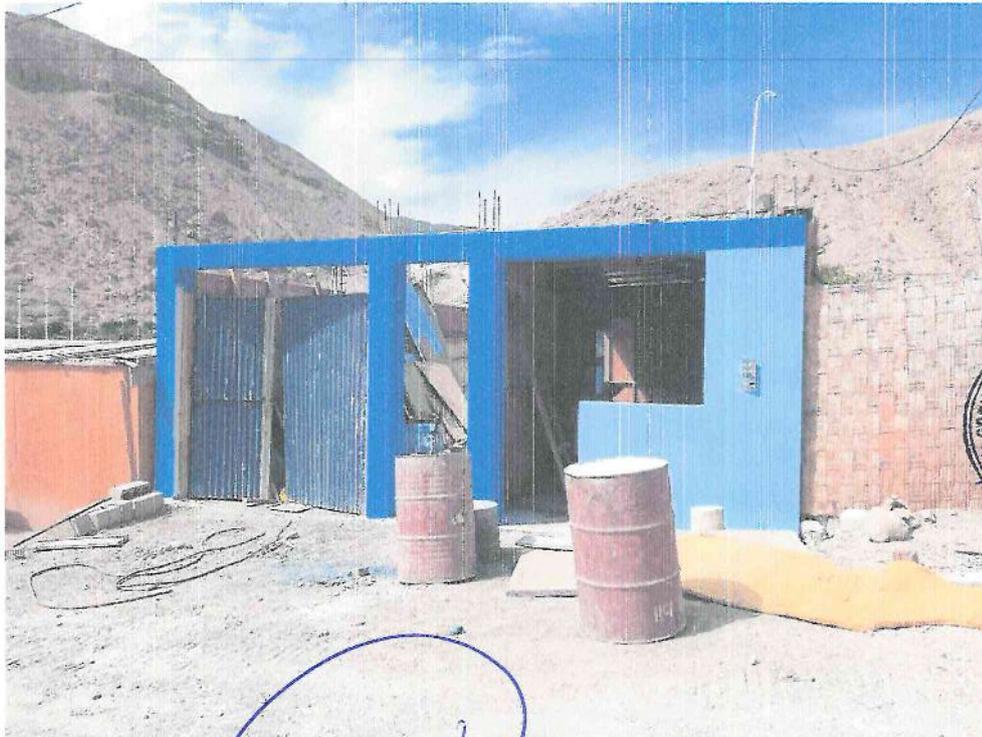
Trabajo de Campo, Vivienda con concreto armado con cobertura ligera sector Caoña.
